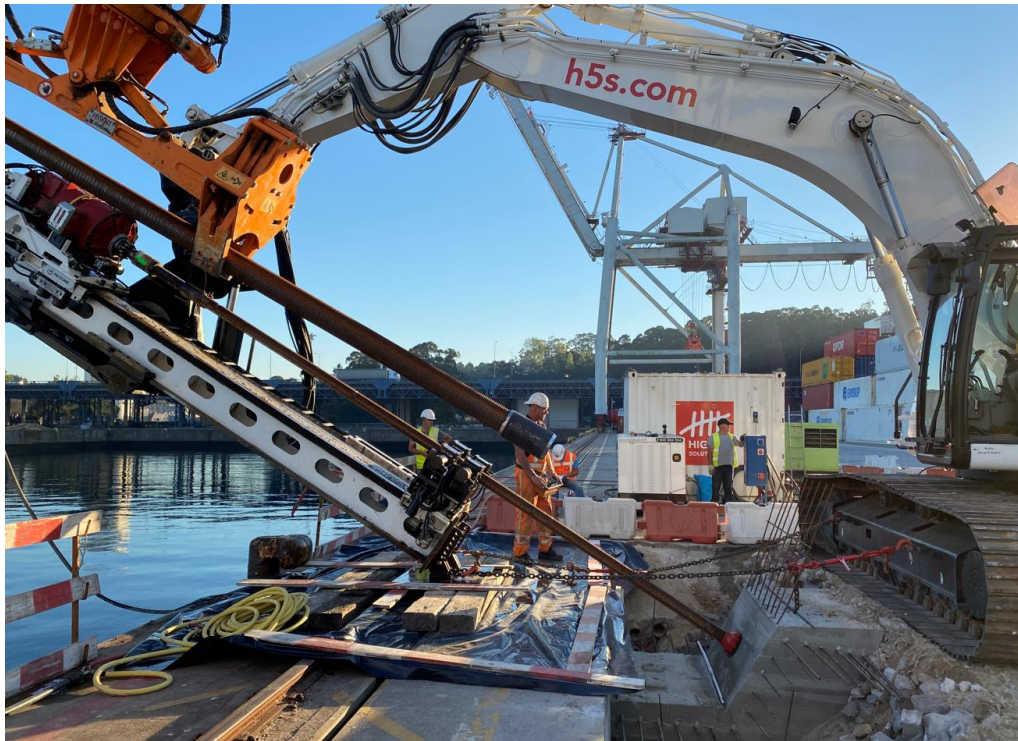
Execução da ancoragem autoperfurante teste, utilizando um troço de viga de encabeçamento como estrutura de reação.
